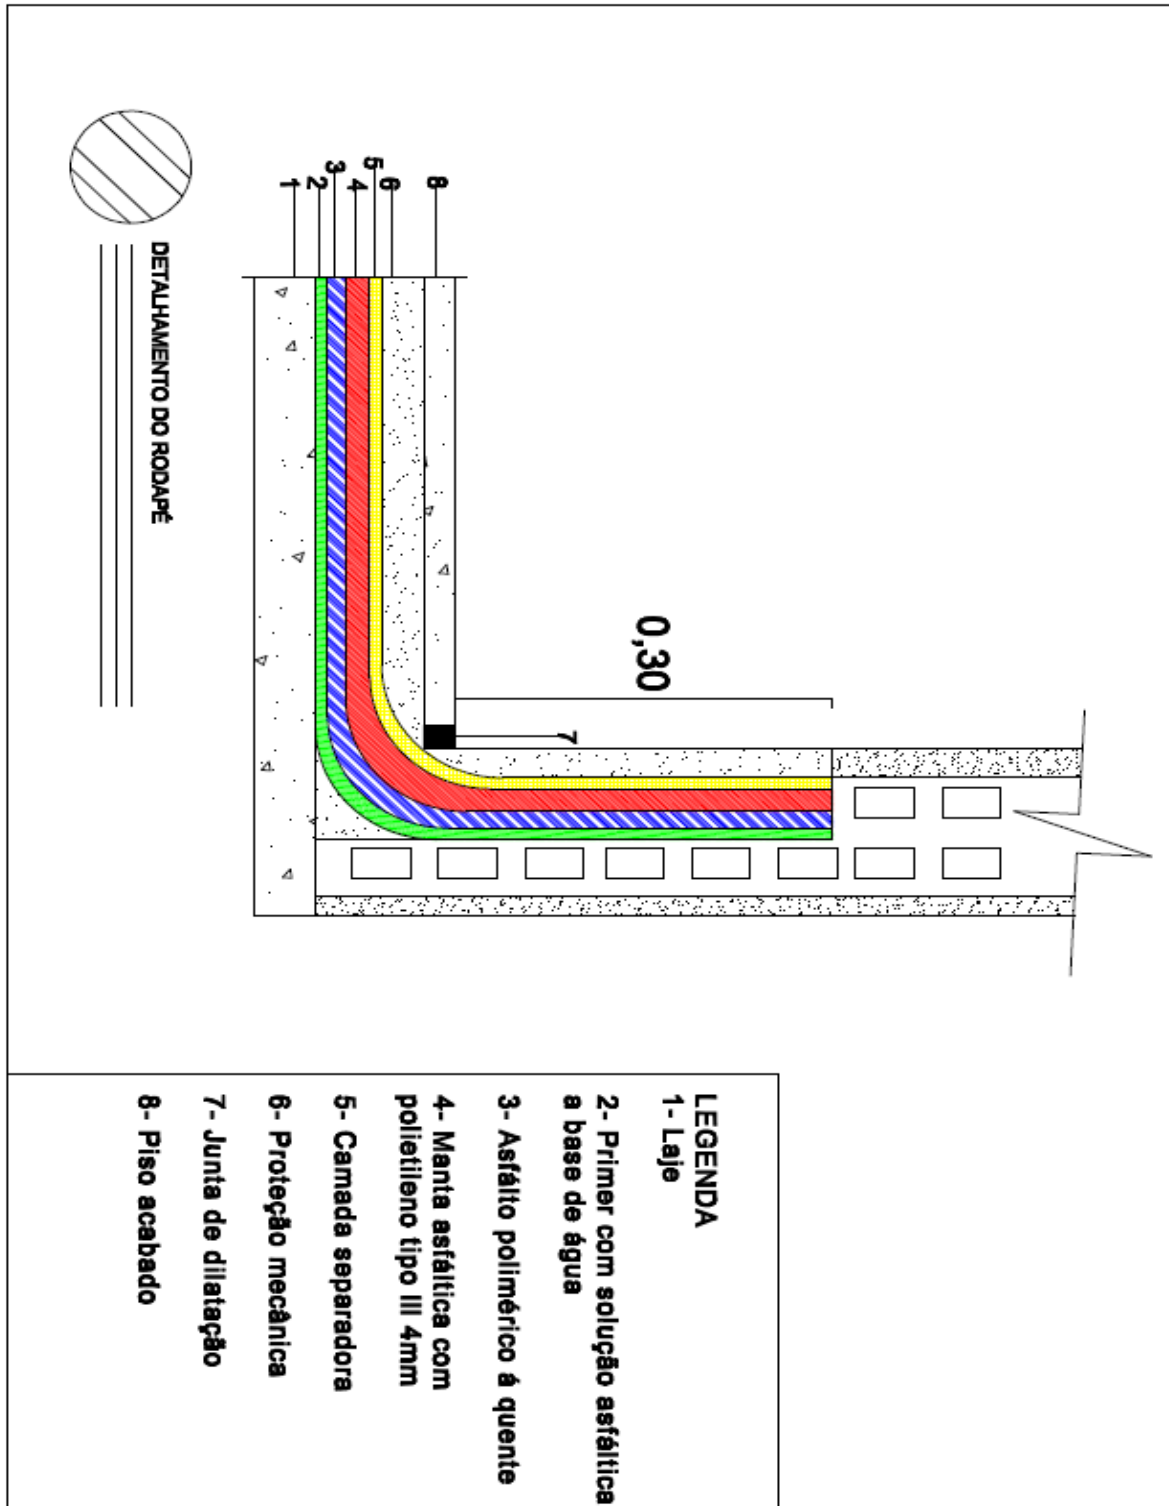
Processo de impermeabilização empregado nas calhas, de acordo com o sistema de impermeabilização.
